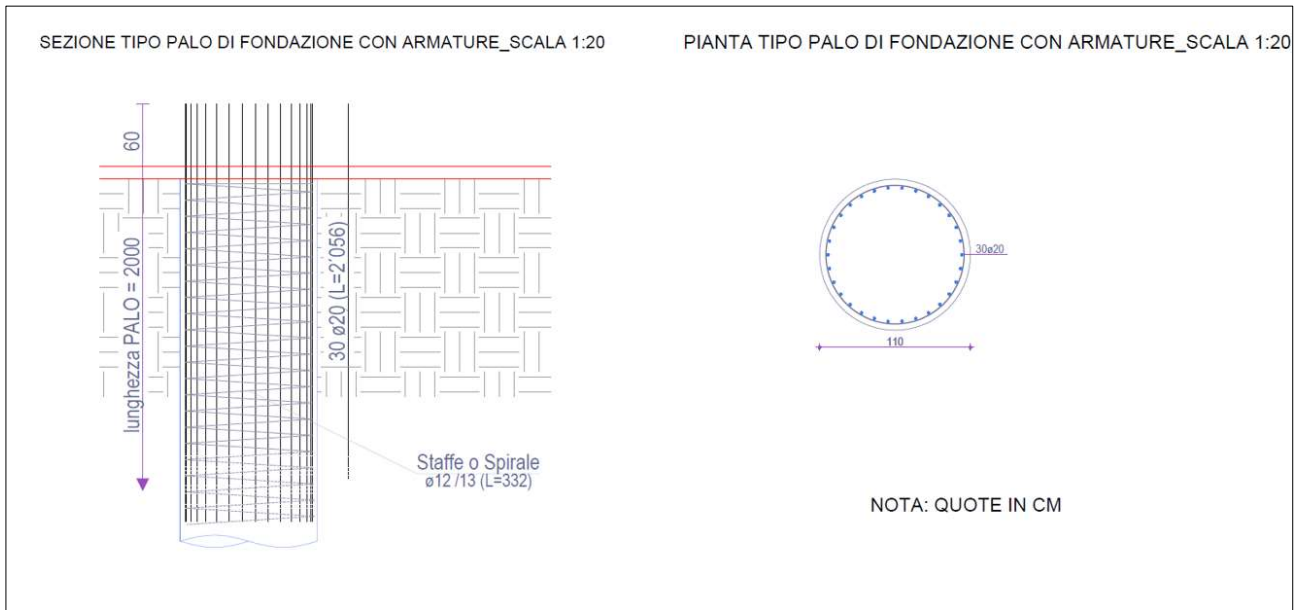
Sezione tipo e pianta tipo palo di fondazione con armature
